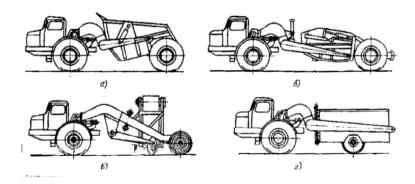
Схемы агрегатирования одноосного тягача с рабочим оборудованием: а – землевозная тележка; б – скрепер; в – грейдер-элеватор; г – пневмоколесный каток
